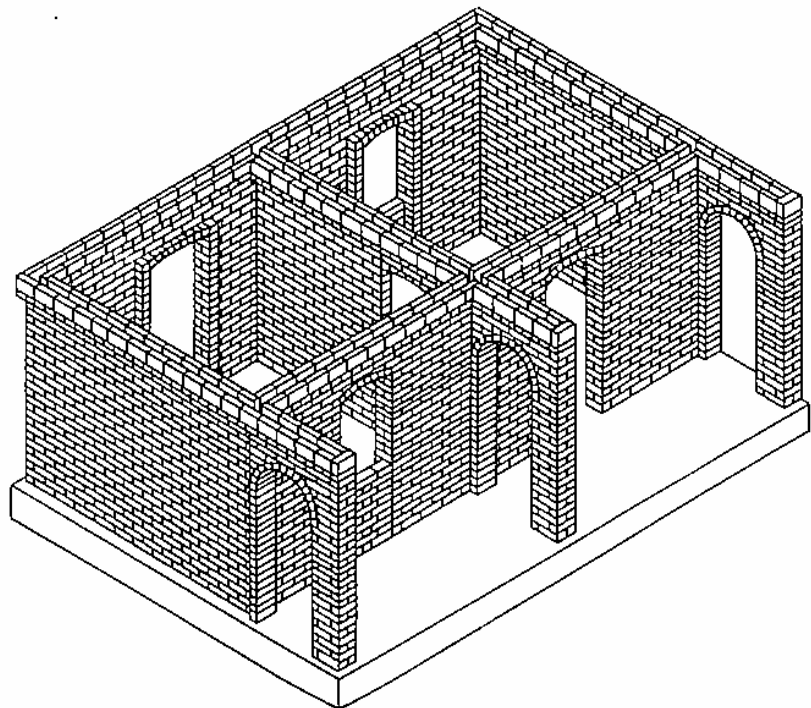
Maçonnerie du coffrage perdu de chaînage, en blocs en boutisse (fond du coffrage) et en blocs sur le chant (joints du coffrage).
